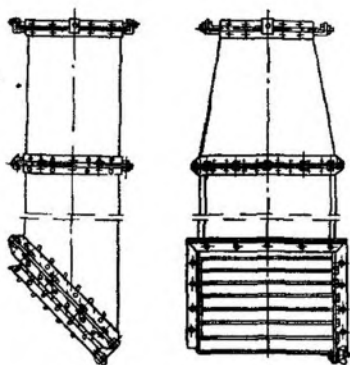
Душирующий патрубок конструкции В. В. Батурина
